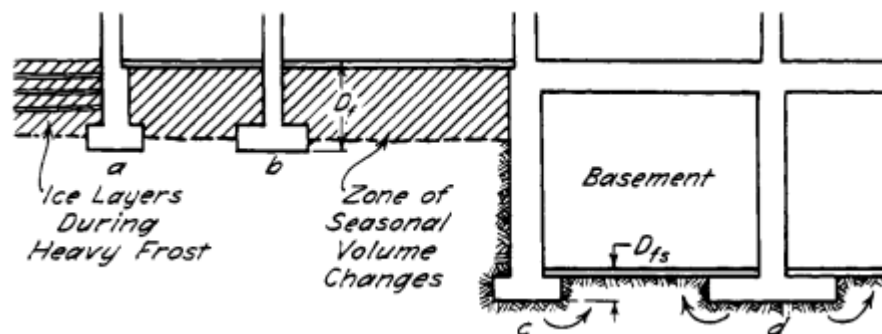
Esquema de disposición de fundaciones superficiales.
